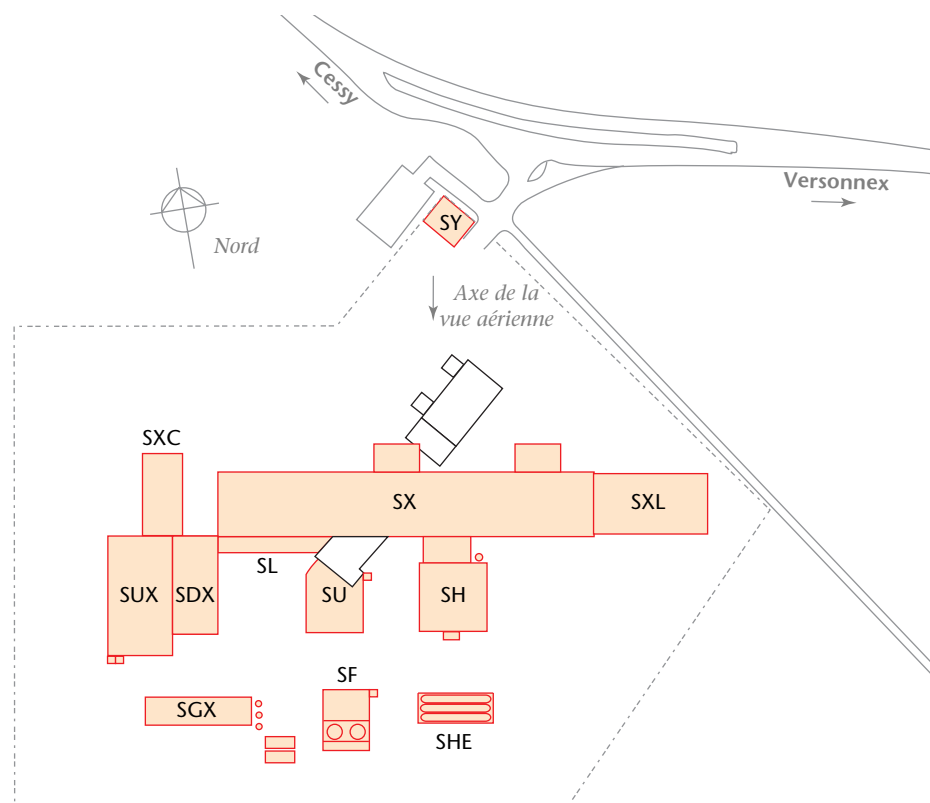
Plan de masse des ouvrages de surface au Point 5 : phase 1
